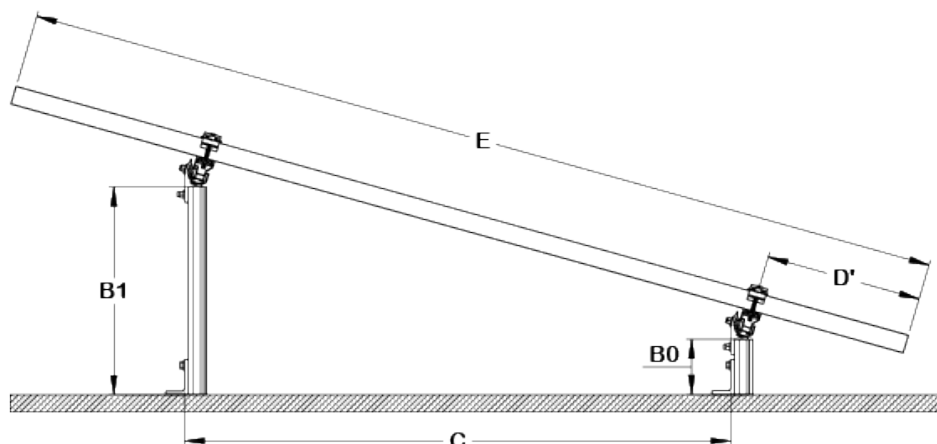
Dimensiones de ensamblaje para el sistema Simple Tilt.
